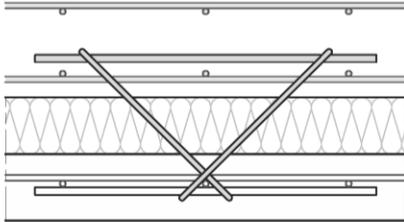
Bewehrung der oberen Schicht einbauen, Zusatzbewehrung entsprechend Anlage 4 Tabelle 2 durch die Bügelenden der Traganker durchstecken und befestigen. Einbindetiefen der Anker gemäß Anlage Tabelle 2 einhalten.
